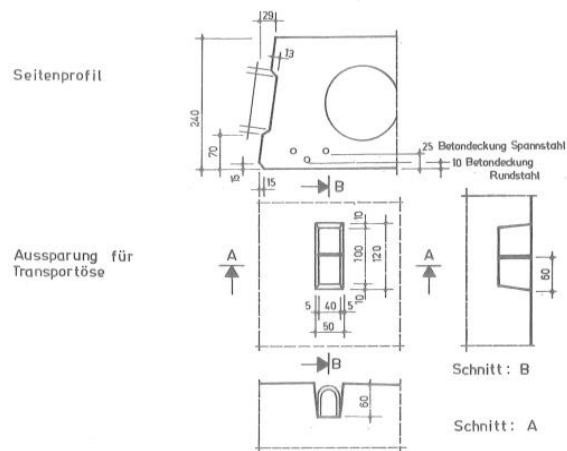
Ausschnitt aus [3] Schnitt Deckenelement
